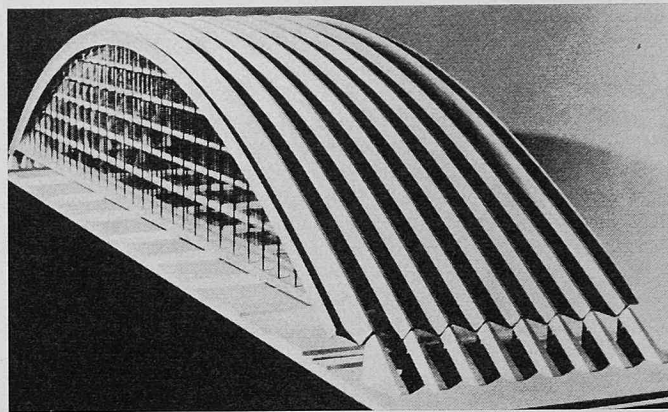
Modell der Gleishalle für das Postamt 3 in München mit 150 m weit gespannten Faltdachbögen aus Spannbetonfertigteilen
